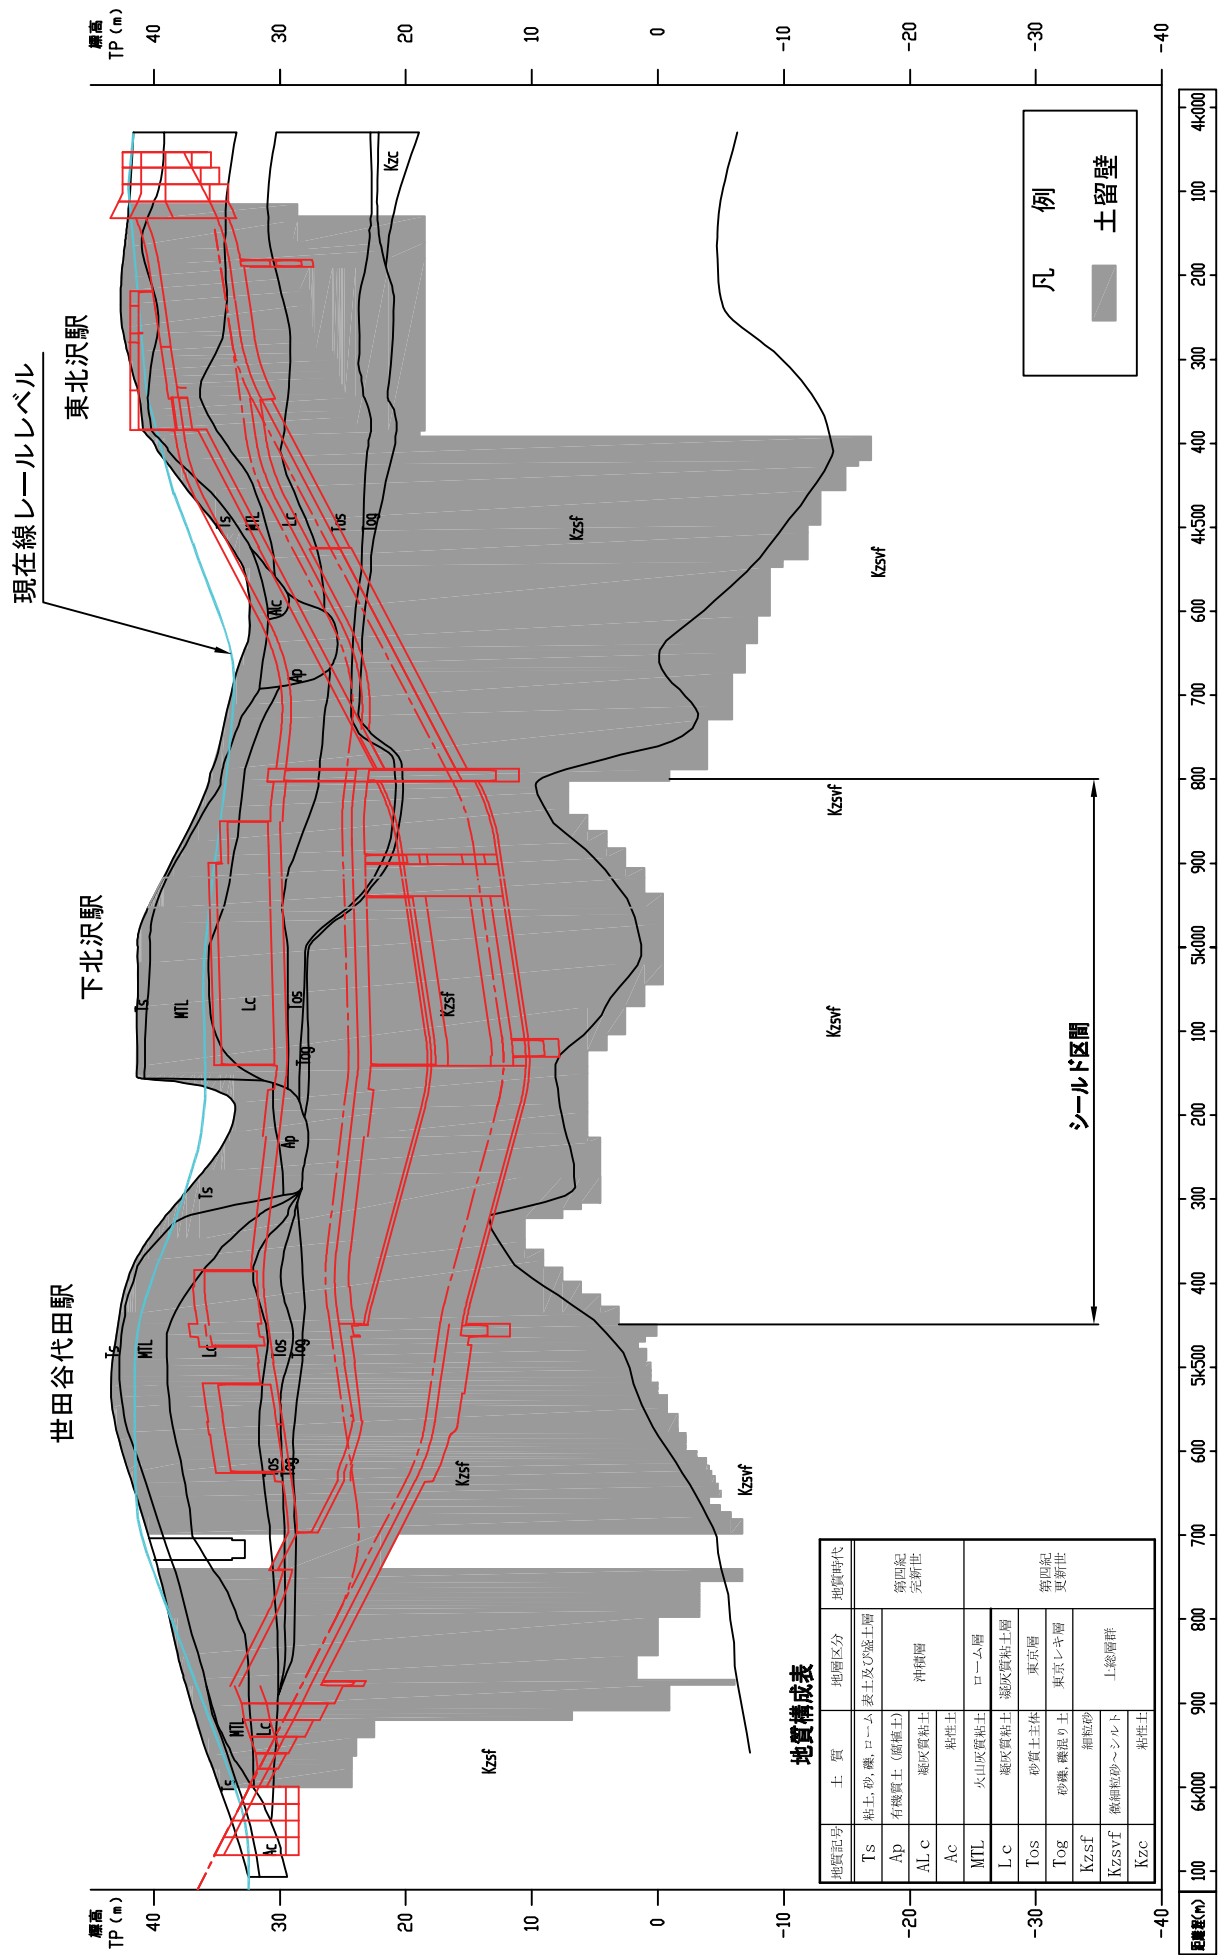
(2) 土留壁の構築状況（縦断面図 北側）
